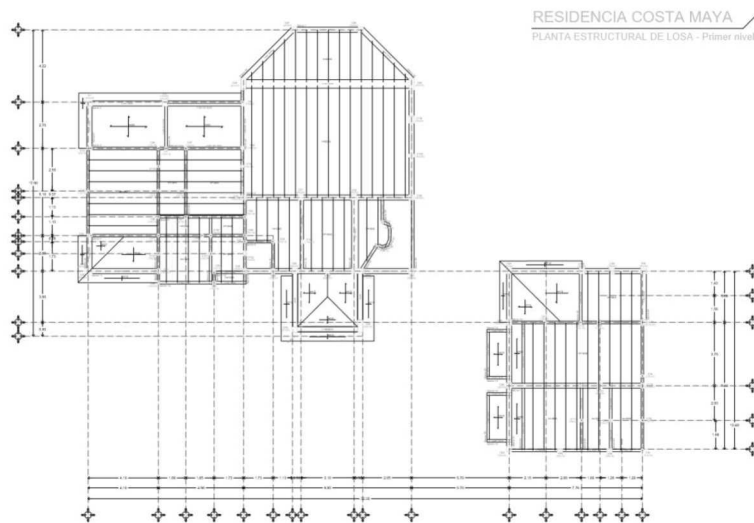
Plantas estructurales de losa primer nivel, con sus respectivos trabes y cadenas.
